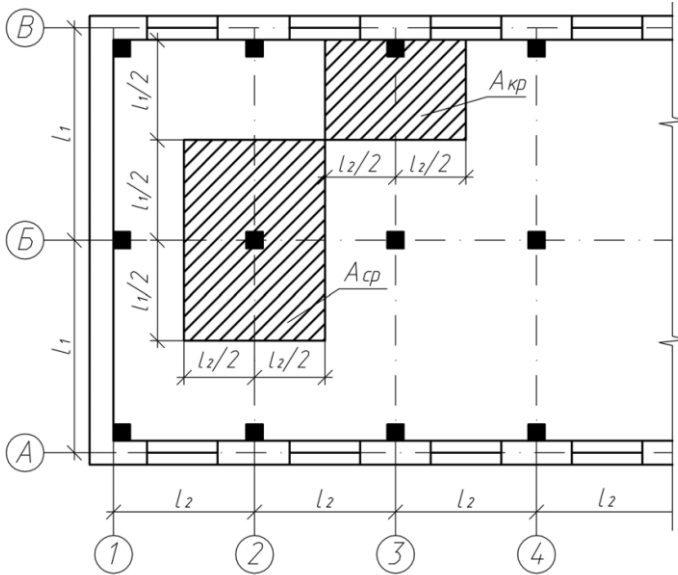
Схематичний план будівлі і визначення вантажних площ.
